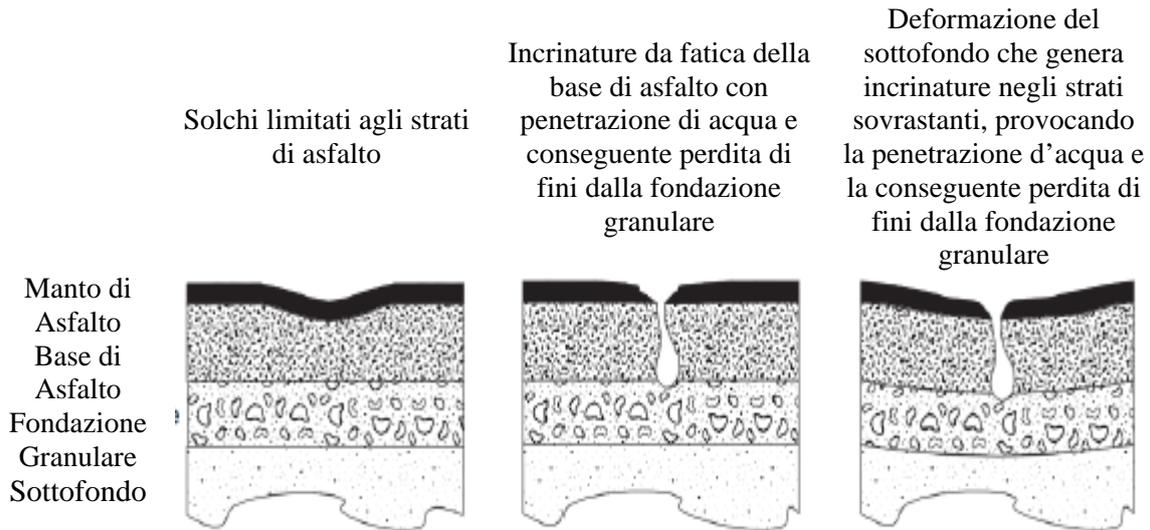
19 - Forme di Deterioramento della Pavimentazione Stradale
